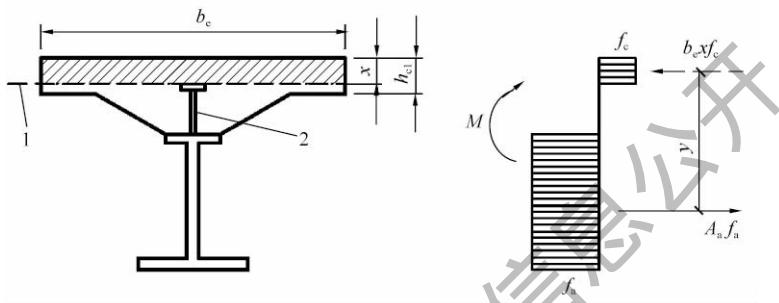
中和轴在混凝土翼板内时的组合梁截面及应力图形
